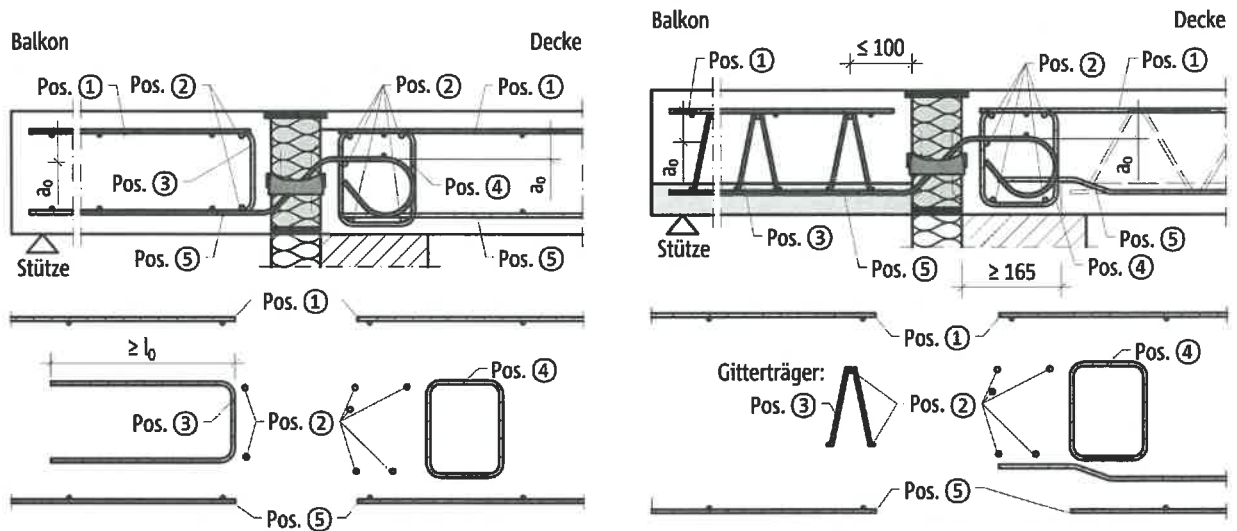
Schöck Isokorb® T Typ Q-V1 bis -V5 6.0, direkte Lagerung: Bauseitige Bewehrung bei Ortbetonbauweise (links) und Fertigteilbauweise (rechts) schematisch dargestellt
